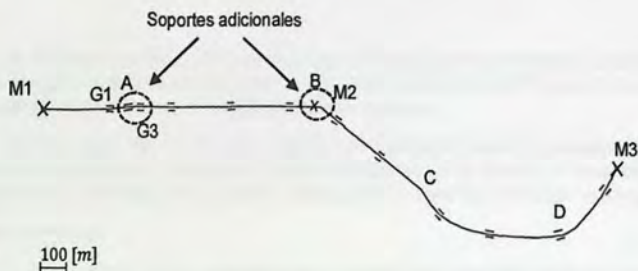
Ubicación de las zonas de los esfuerzos y desplazamientos relevantes, cañería con guías equidistantes.
